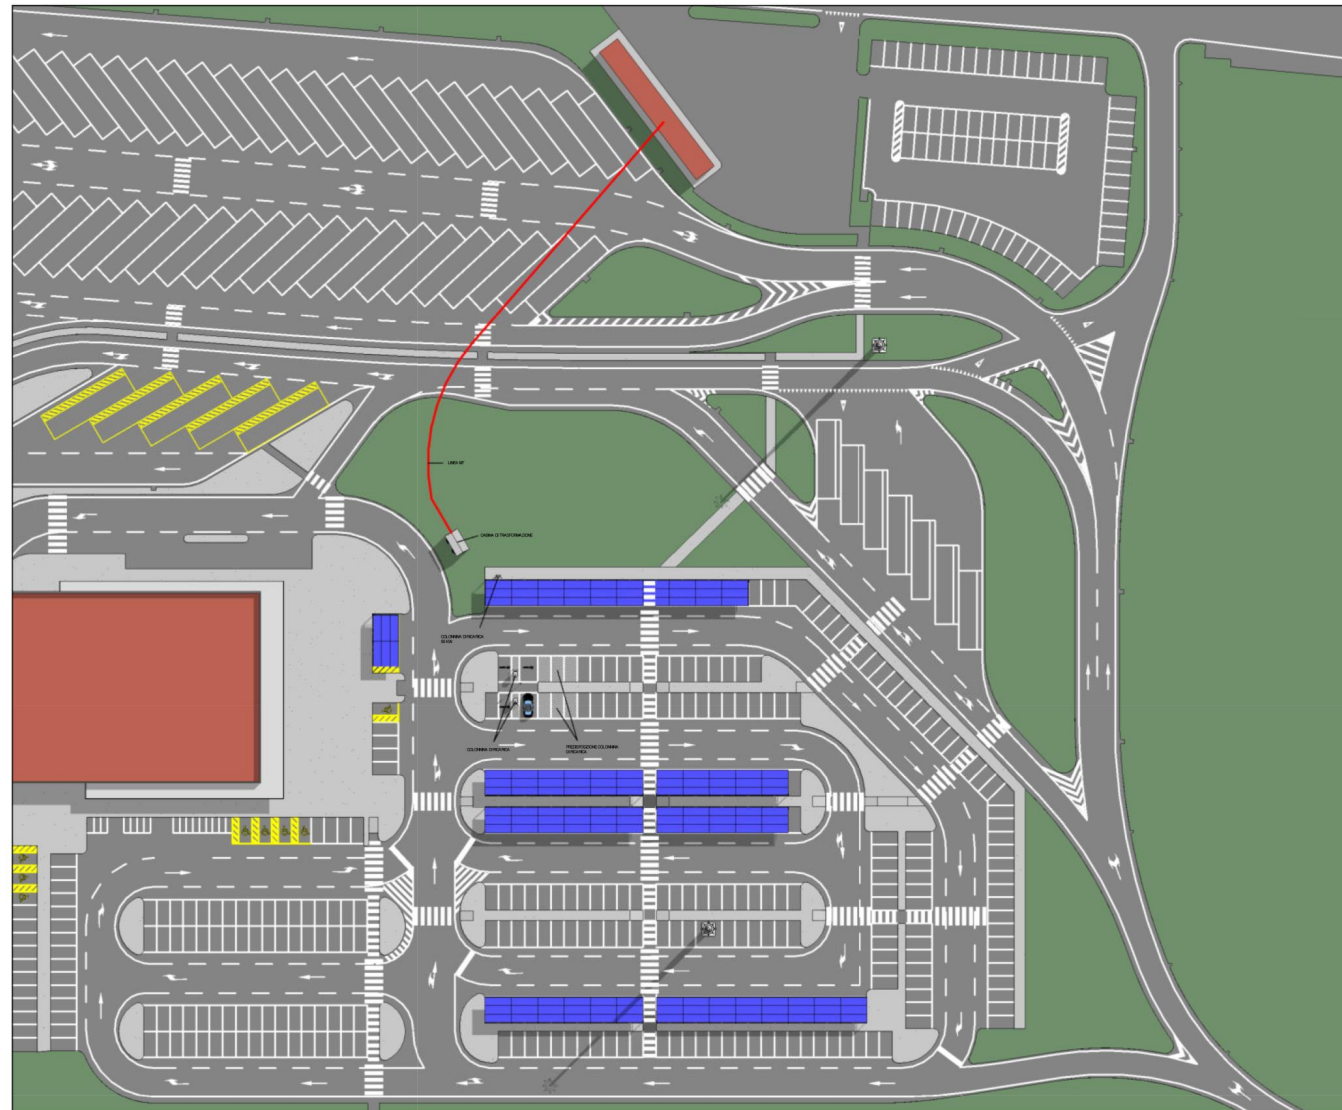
Area di Servizio Sillaro est - Planimetria
